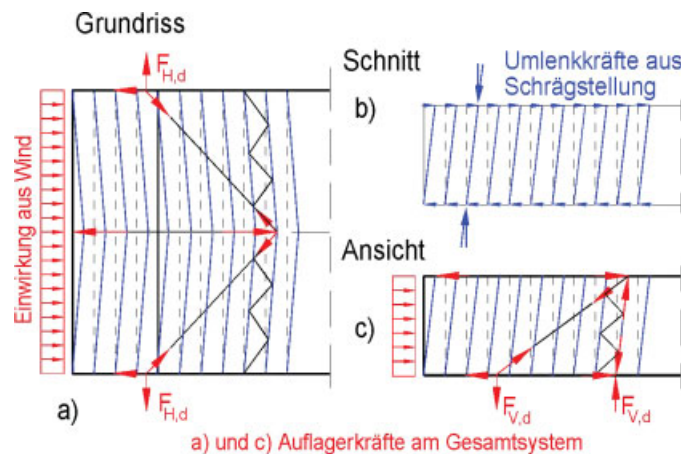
Dach mit Bindern, a) Draufsicht mit Windbelastungen und Abspannungen durch Windrispen am First, b) Umlenkkräfte aus der Schrägstellung der Binder am First und an den Traufen, c) Auflagerkräfte am Gesamtsystem
